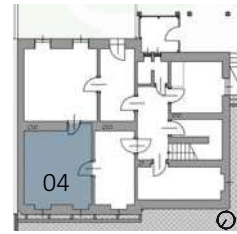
Zimmer Straßenseite, Blick Richtung Wand a und b.
